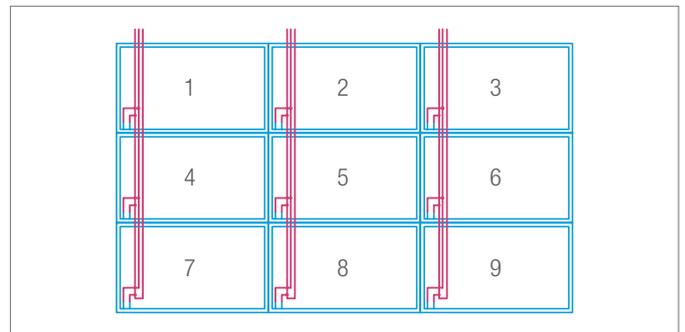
Schematische Darstellung der Installationsreihenfolge der Deckenelemente kleiner Deckenflächen
